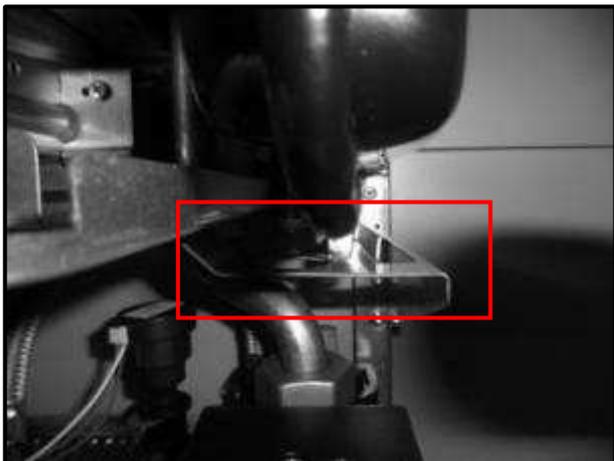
Установка пластмассового проходника для приходящей отопительной трубы.
